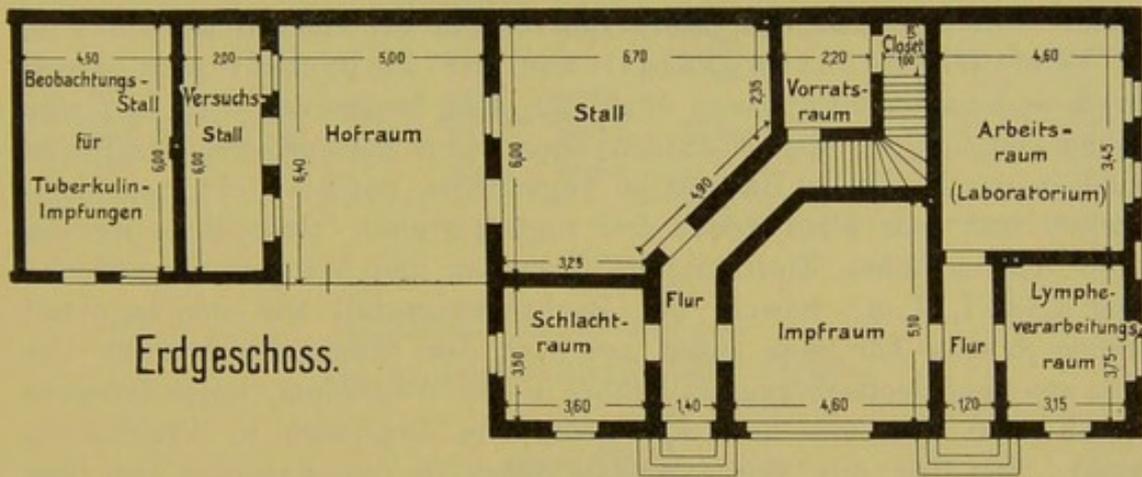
Impfanstalt in Oppeln: Grundriß des Erdgeschosses.
